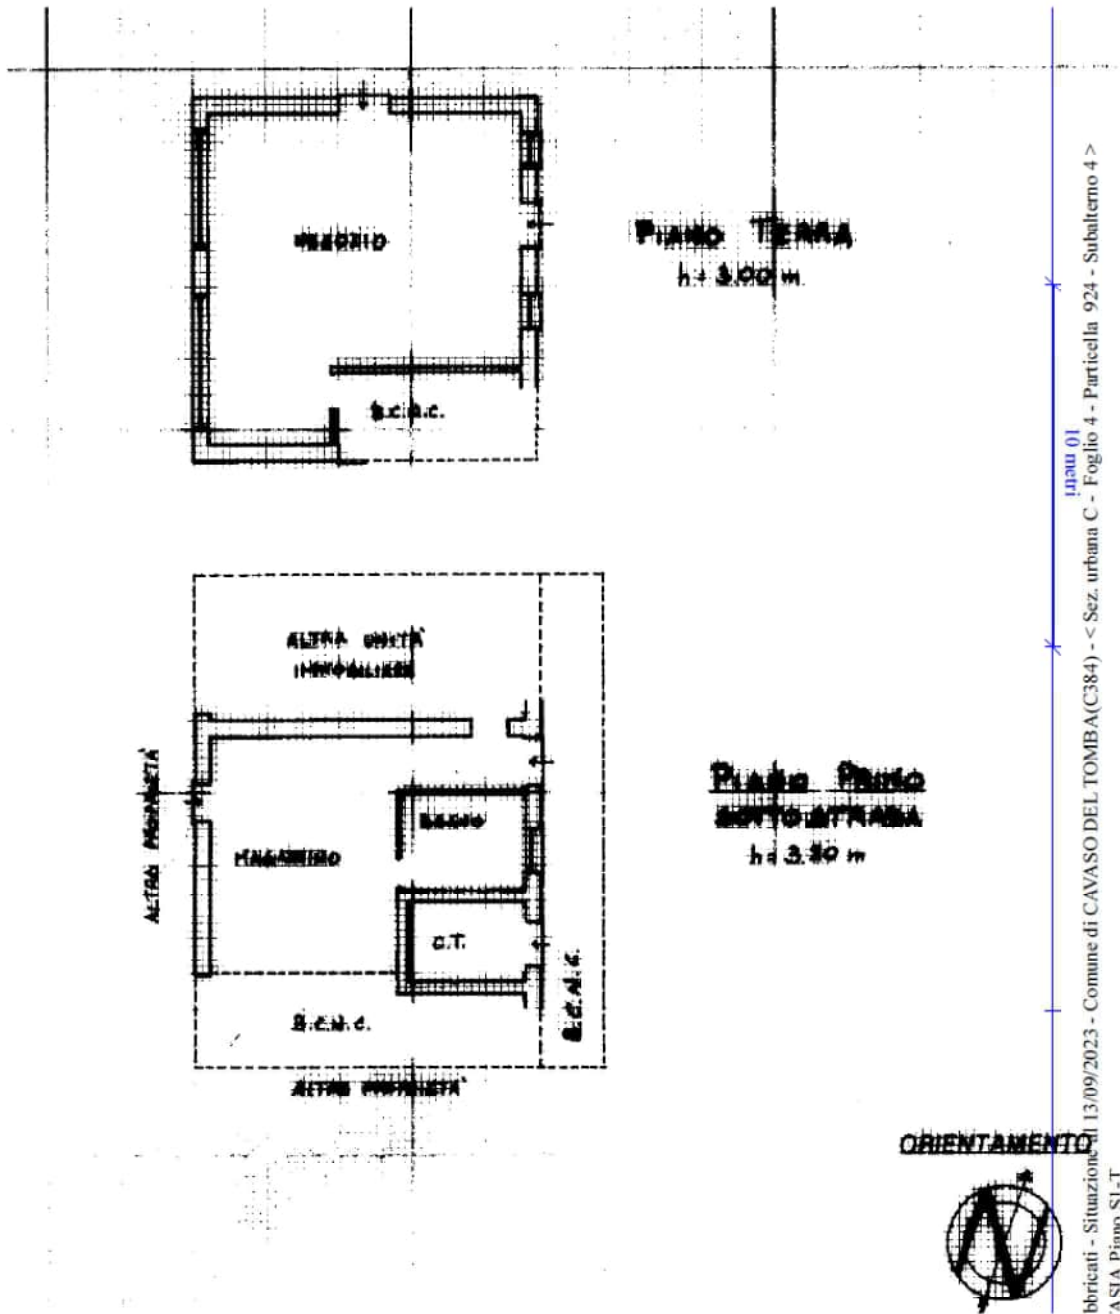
a: Estratto Planimetria catastale Mappale 924, Sub. 4 – non in scala
